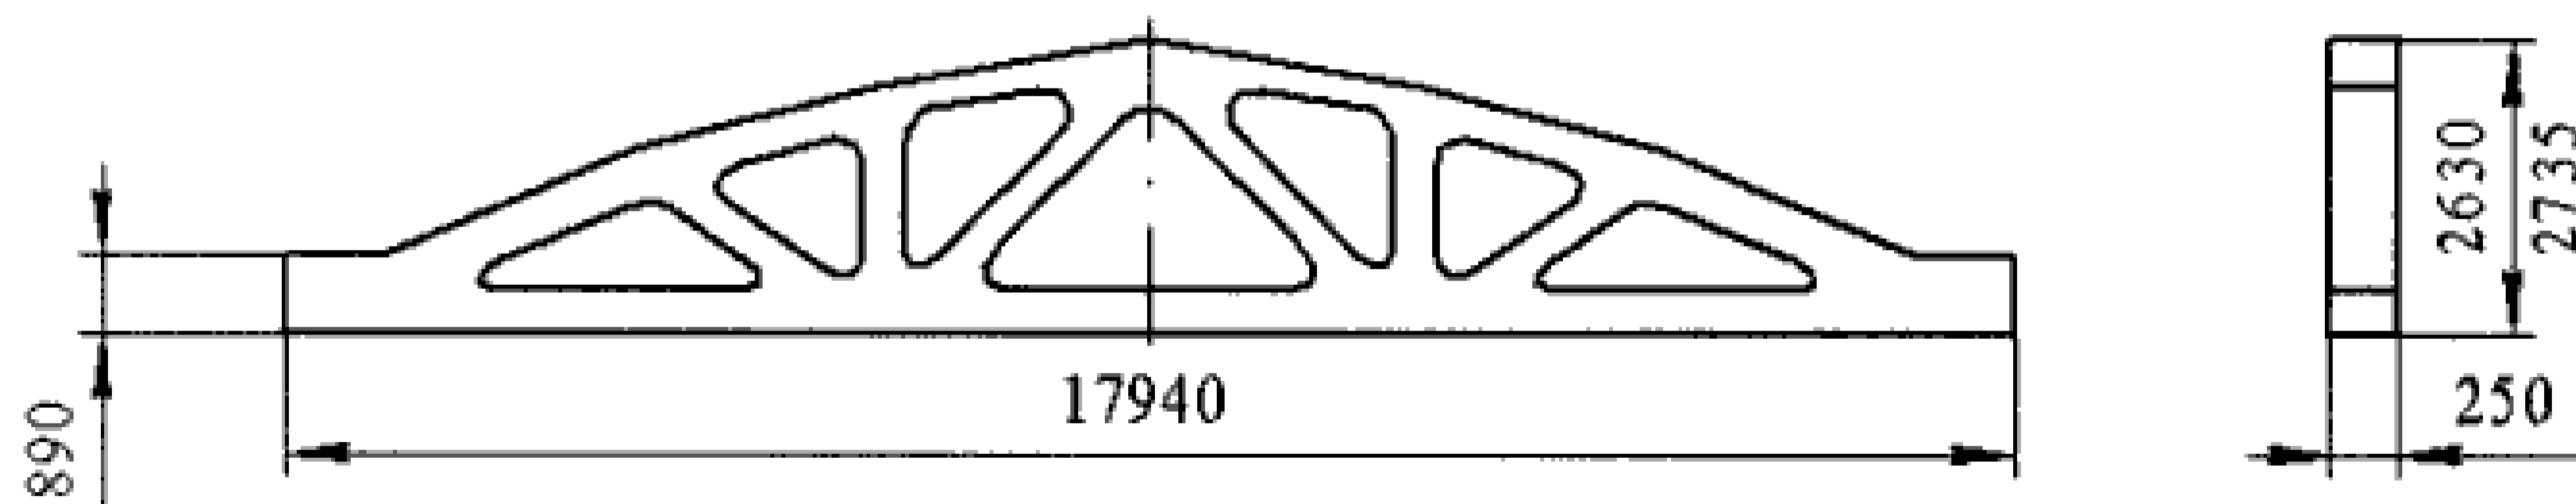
Габаритные размеры железобетонных ферм
